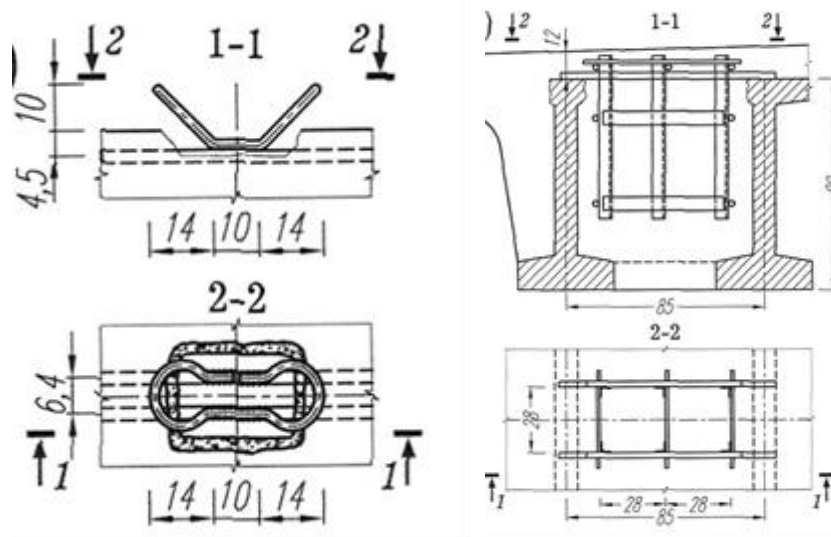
Деталі об'єднання накладної залізобетонної плити з вживаними балками:
